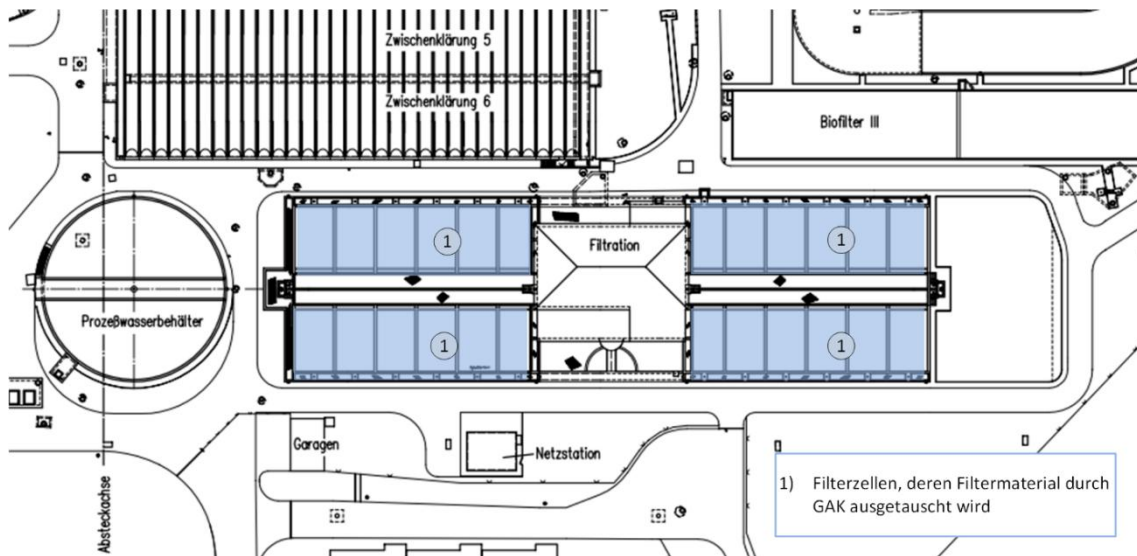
Lageplan der Variante 6 auf dem Klärwerk Krefeld
